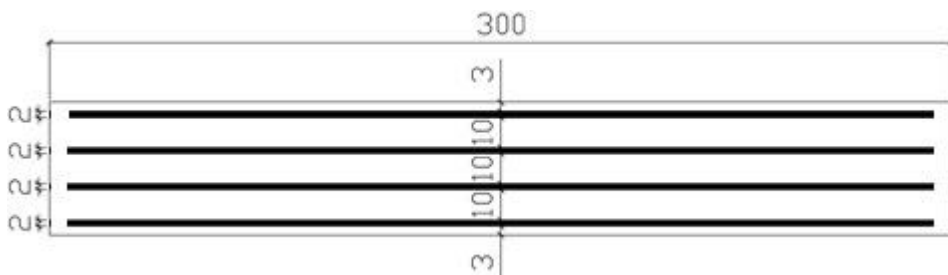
Detalhe da seção AA, na direção longitudinal da ponte (medidas em mm)
